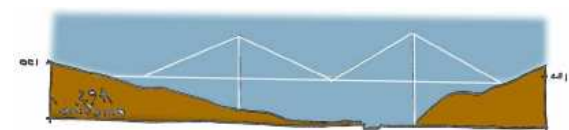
profil en long d'une solution plus tranchée, plus plate, plus haute.
